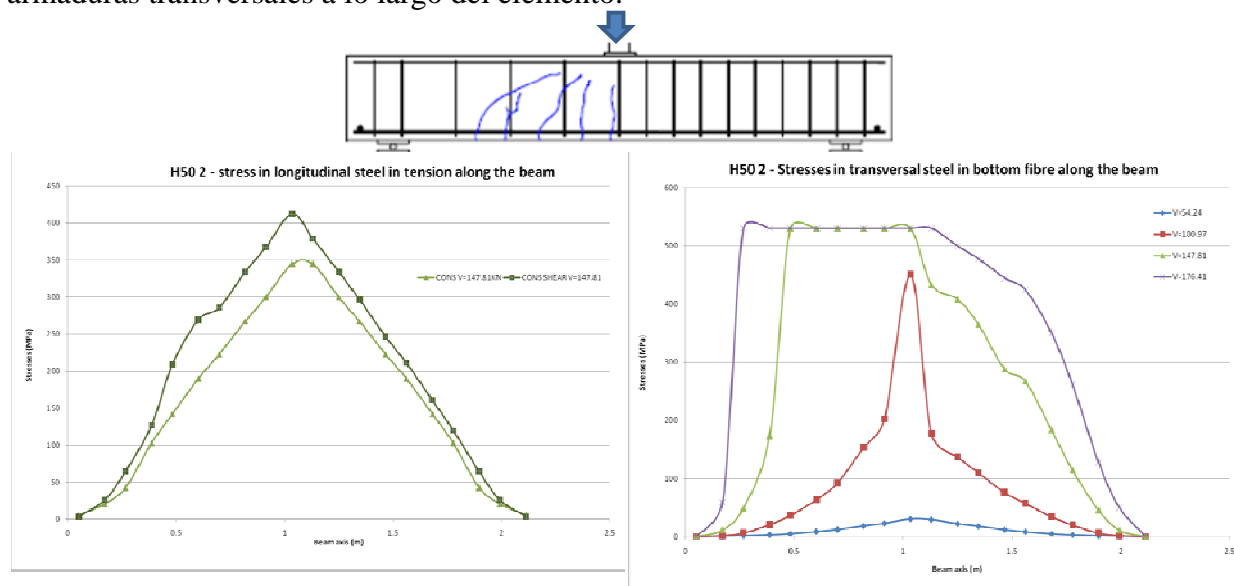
Predicción tensiones armaduras longitudinales y transversales
